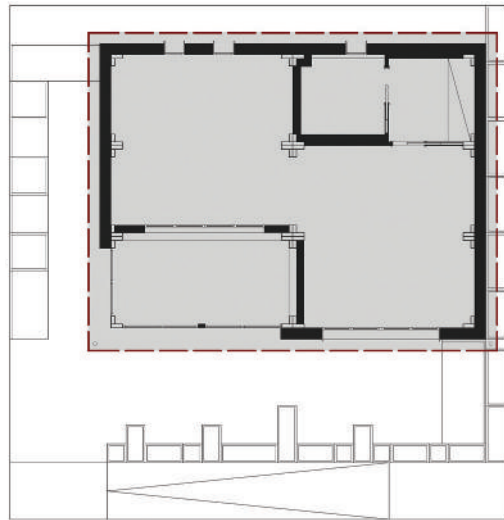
\_ Pianta \_ Scala 1:200
